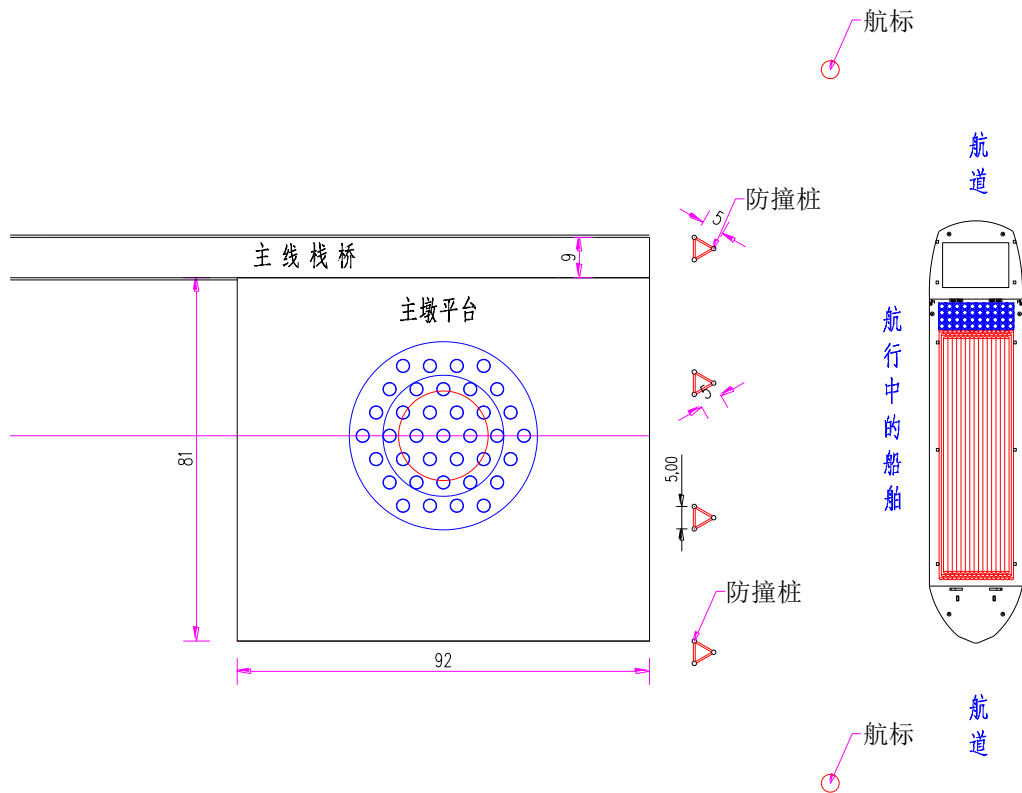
临时防撞设施布置图 (尺寸单位: m)
